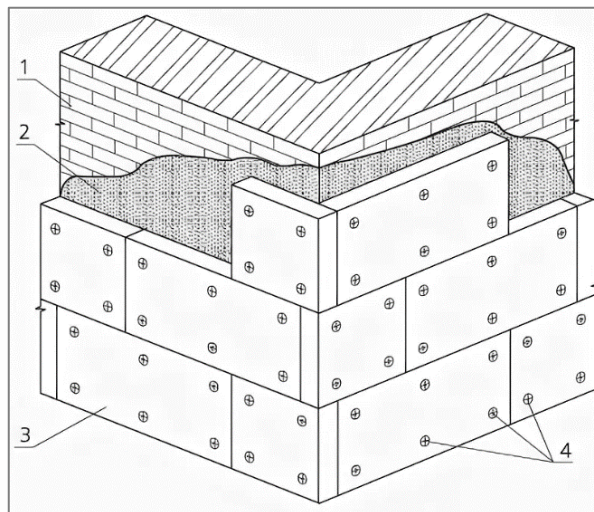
Схема монтажа утеплителя навесного и мокрого фасадов:
